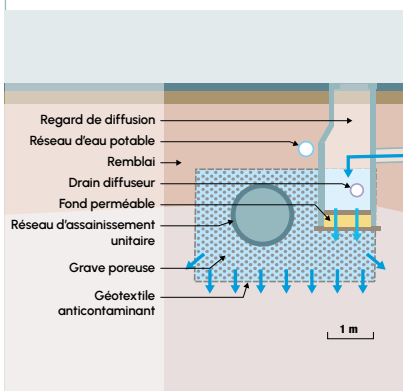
Coupe type d'une tranchée mutualisée ASS + AEP
